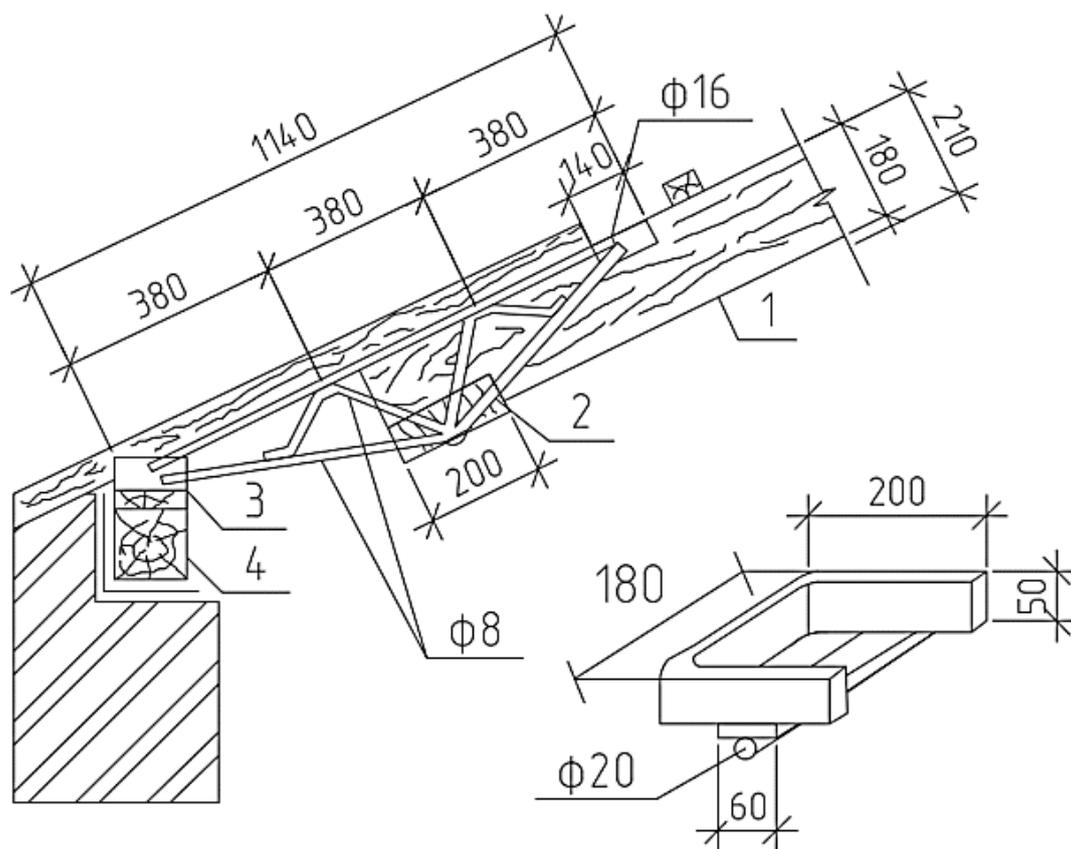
Стропильный протез типа КС-1-С: 1 – стропильная нога; 2 – нижний опорный узел; 3 – подкладки; 4 – подстропильный брус (мауэрлат)
